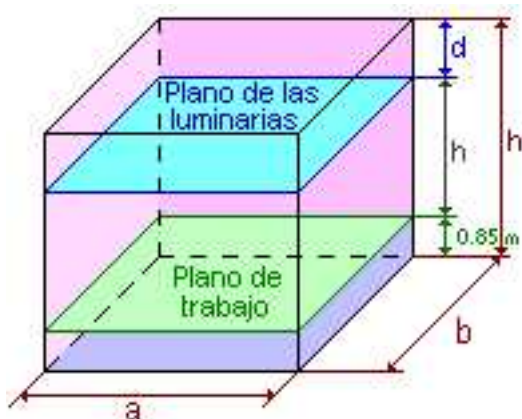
Esquema en donde se muestra el plano de trabajo y el plano de las luminarias.
